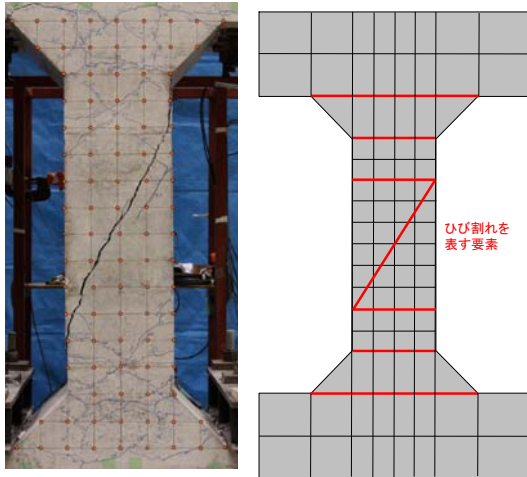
試験体 No.2 のひび割れ進展状況とそのモデル化
